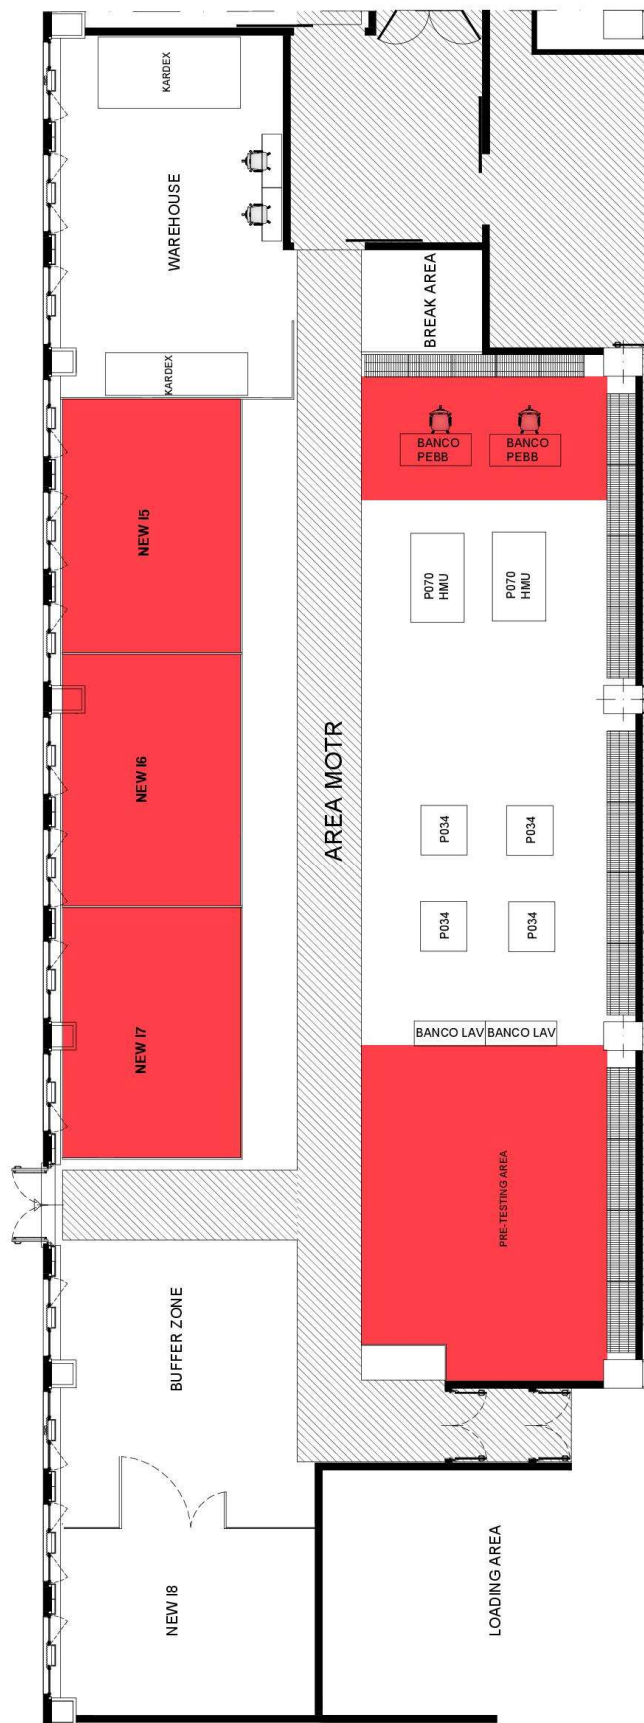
Planimetria di progetto dell'area nord attualmente in uso (in rosso sono evidenziate le zone di nuova concezione)
